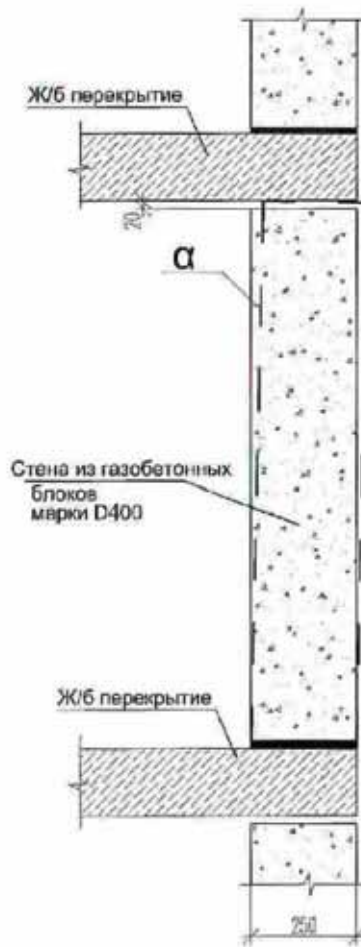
Схема возможного опрокидывания фрагмента стенового заполнения и его защемления верхним перекрытием
